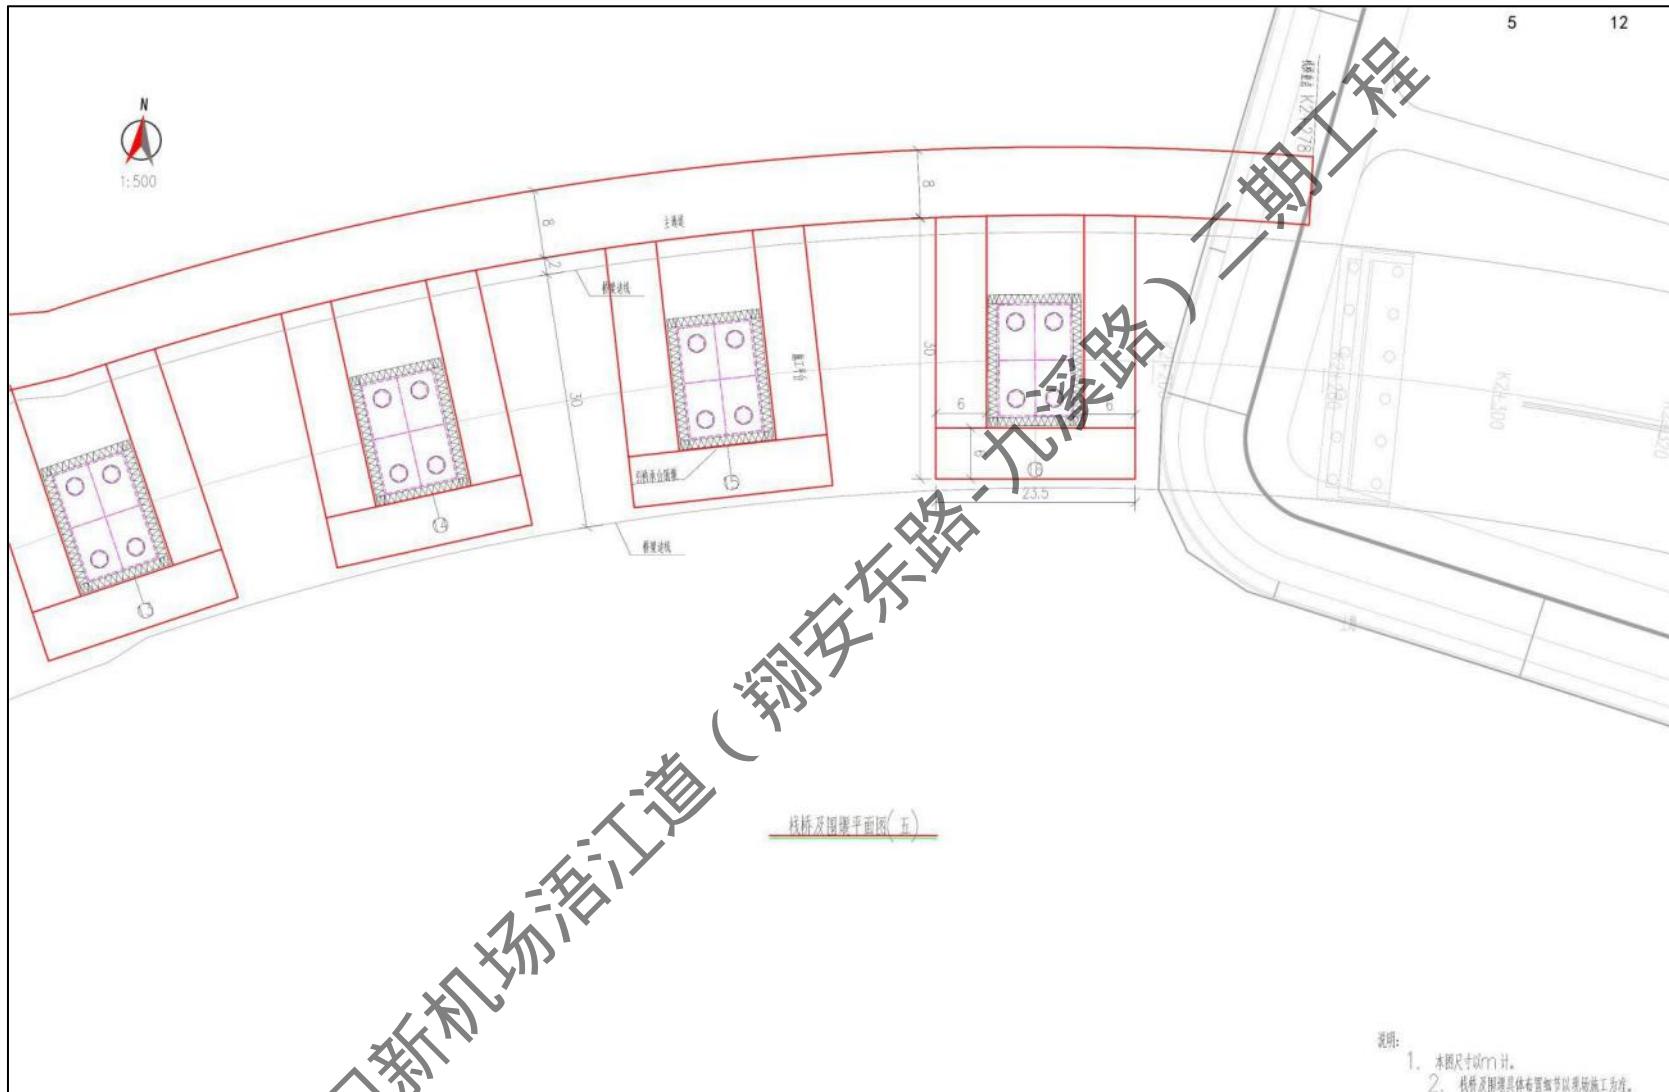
施工栈桥及围堰平面布置图 (五)
